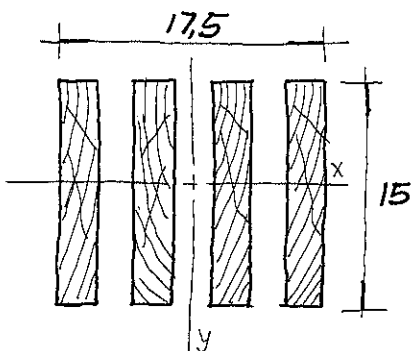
Seção da Coluna Interna do Pilar
